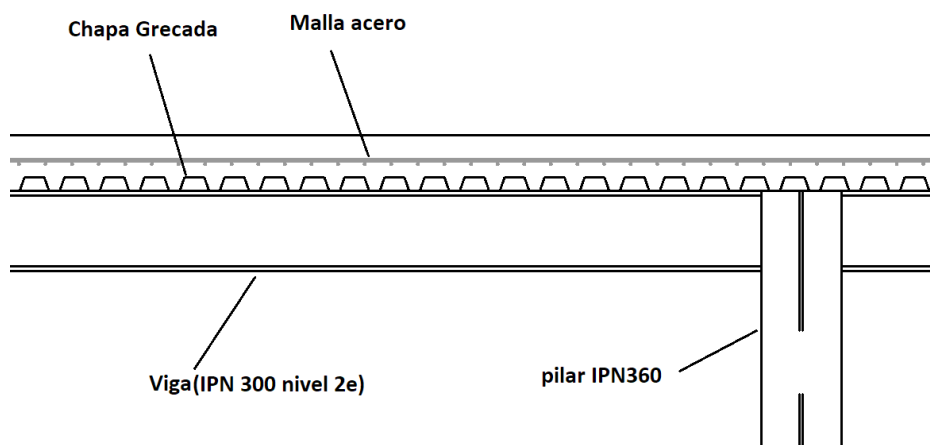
Detalle de colocación de Forjado en Alzado Oeste.
